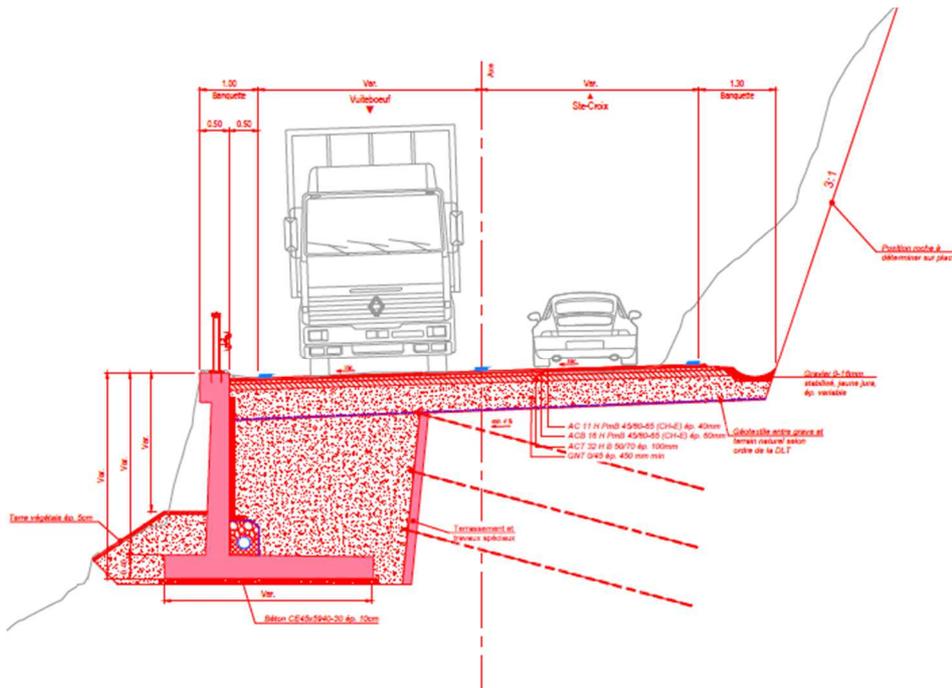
Elargissement de chaussée avec un mur du côté aval de la route.
